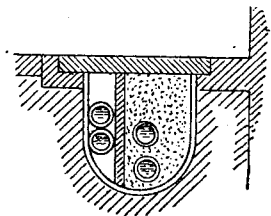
Colocación de las tuberías debajo del pavimento.
